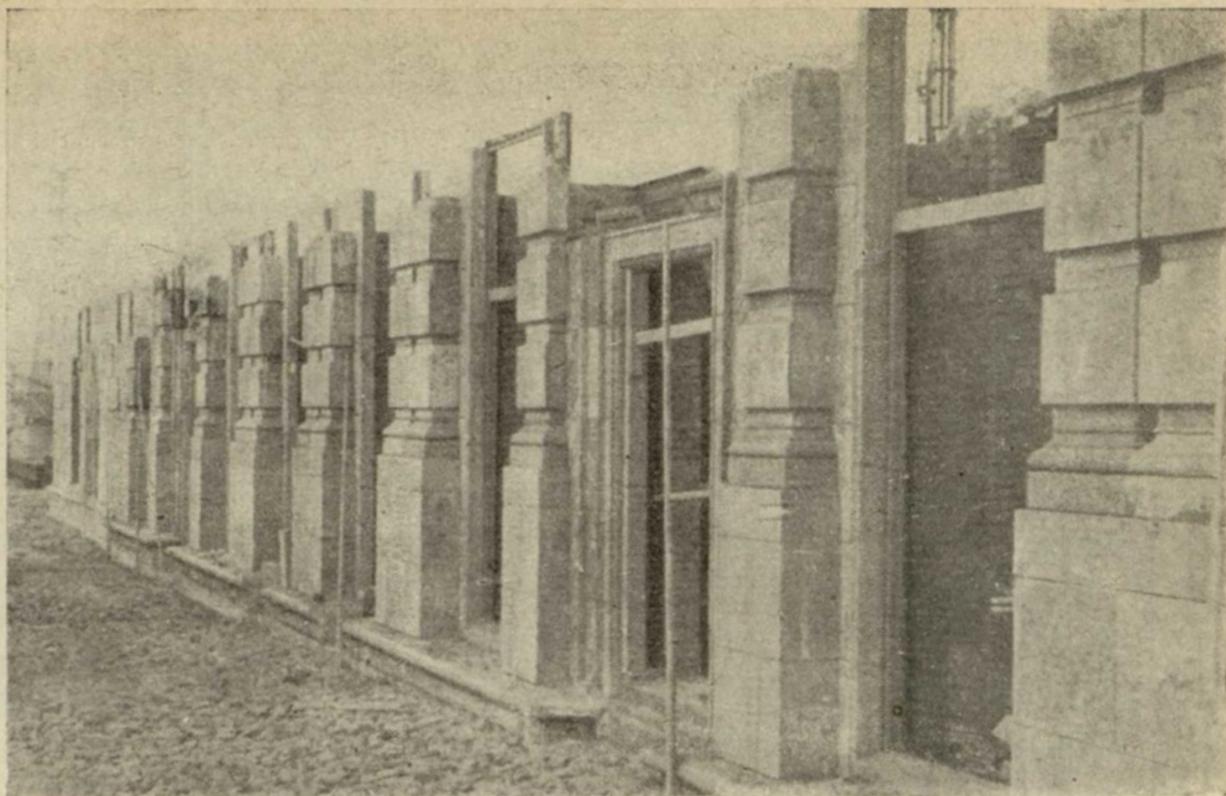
Облицовка фасада плитами и архитектурными деталями по ходу кладки (строительство Дома СНК РСФСР по Саринскому проезду).
